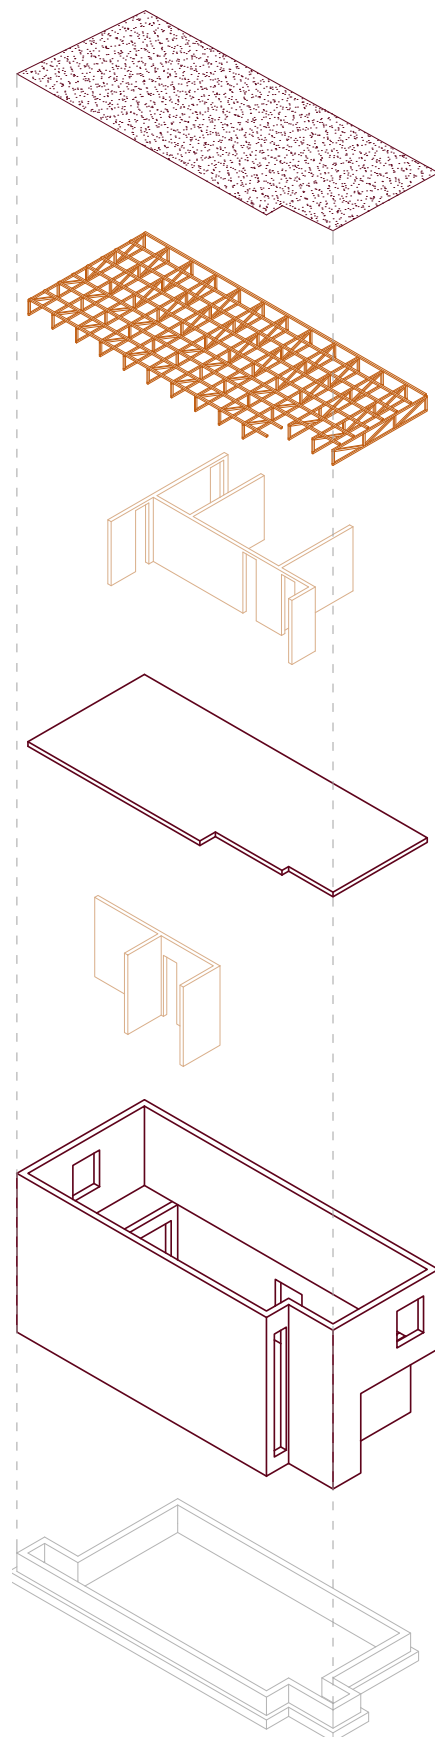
Sistema estructural tipo A1. Fuente: Elaboración propia (2023), en base a trabajo de campo.
